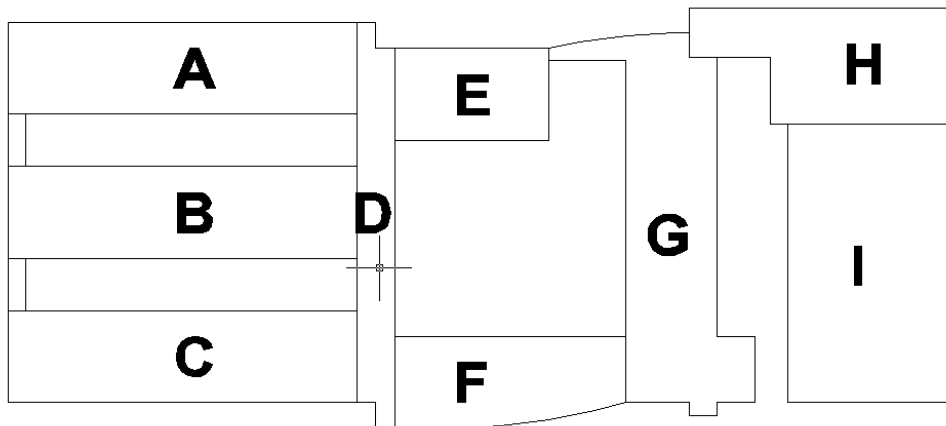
Planta de Identificação dos Corpos Estruturais.
